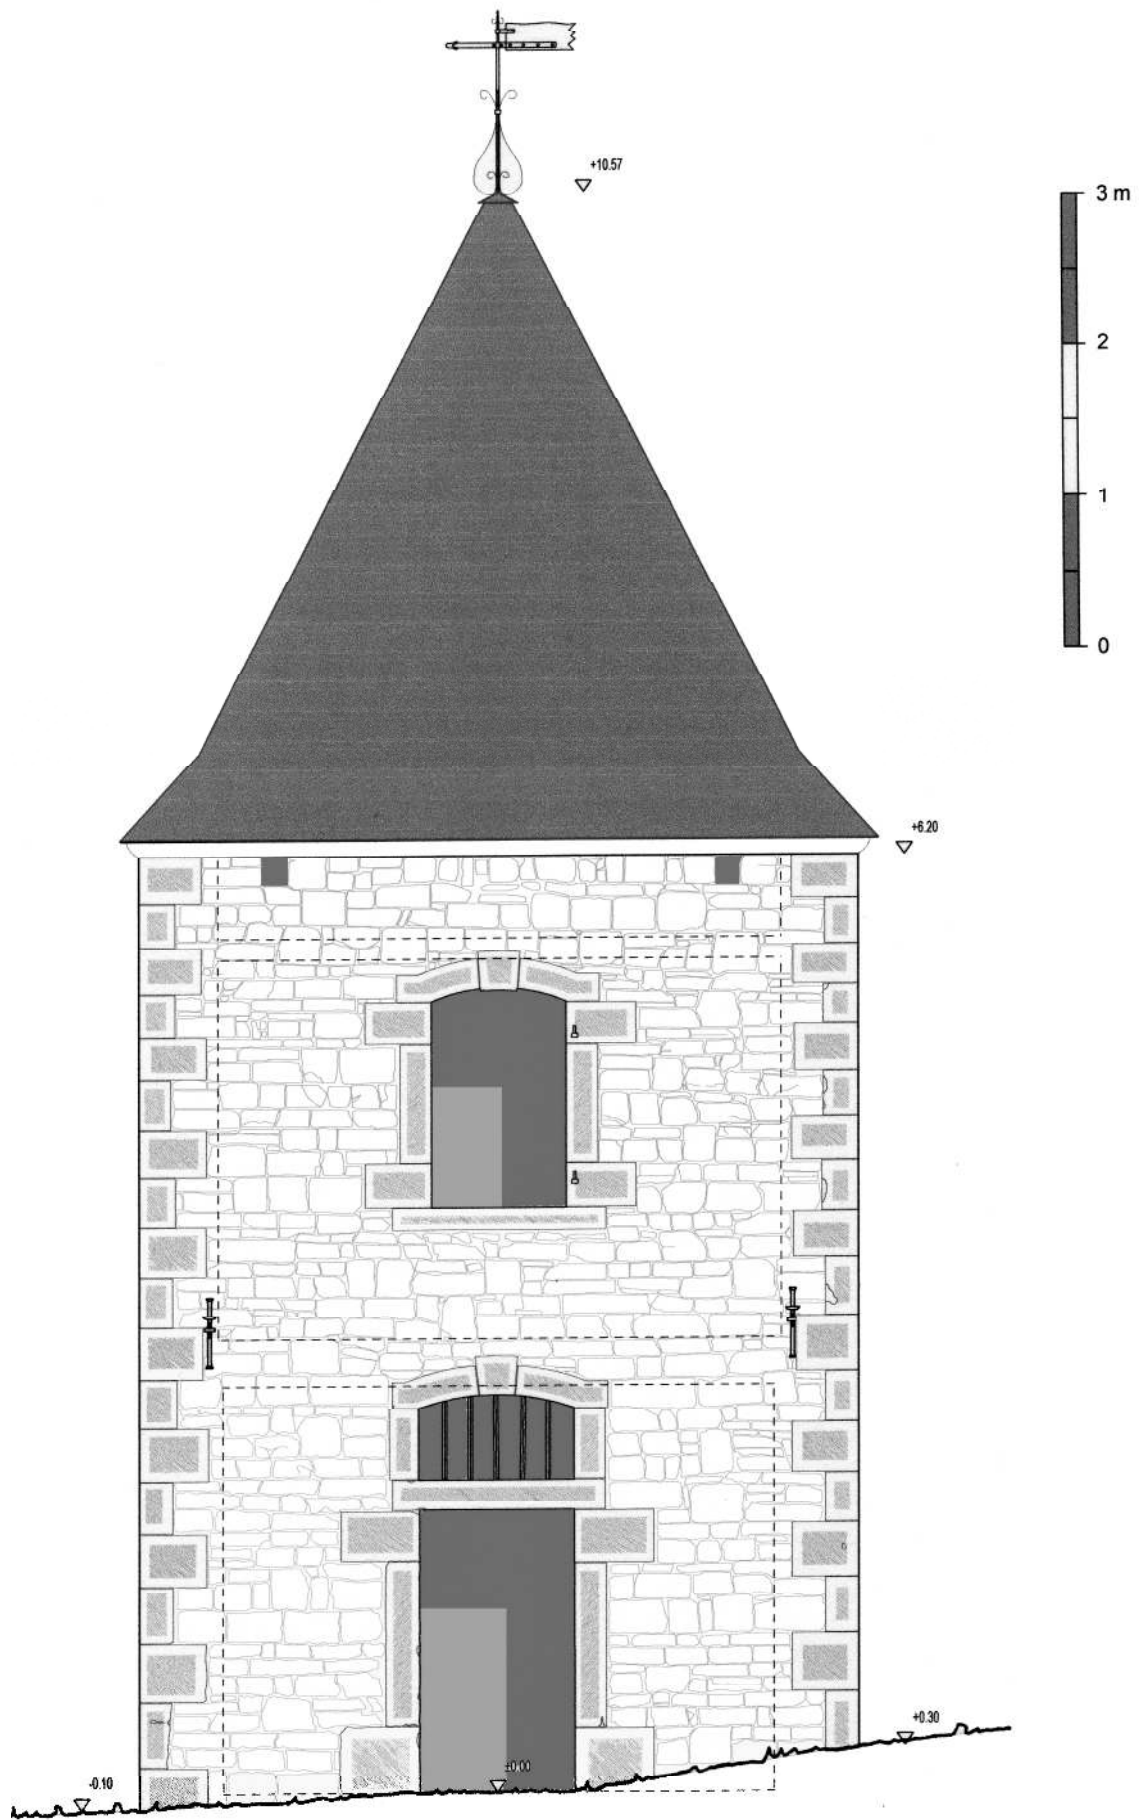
Pavillon. Elévation NO. Ech. 1/50^e. Situation existante. IG 2003.
